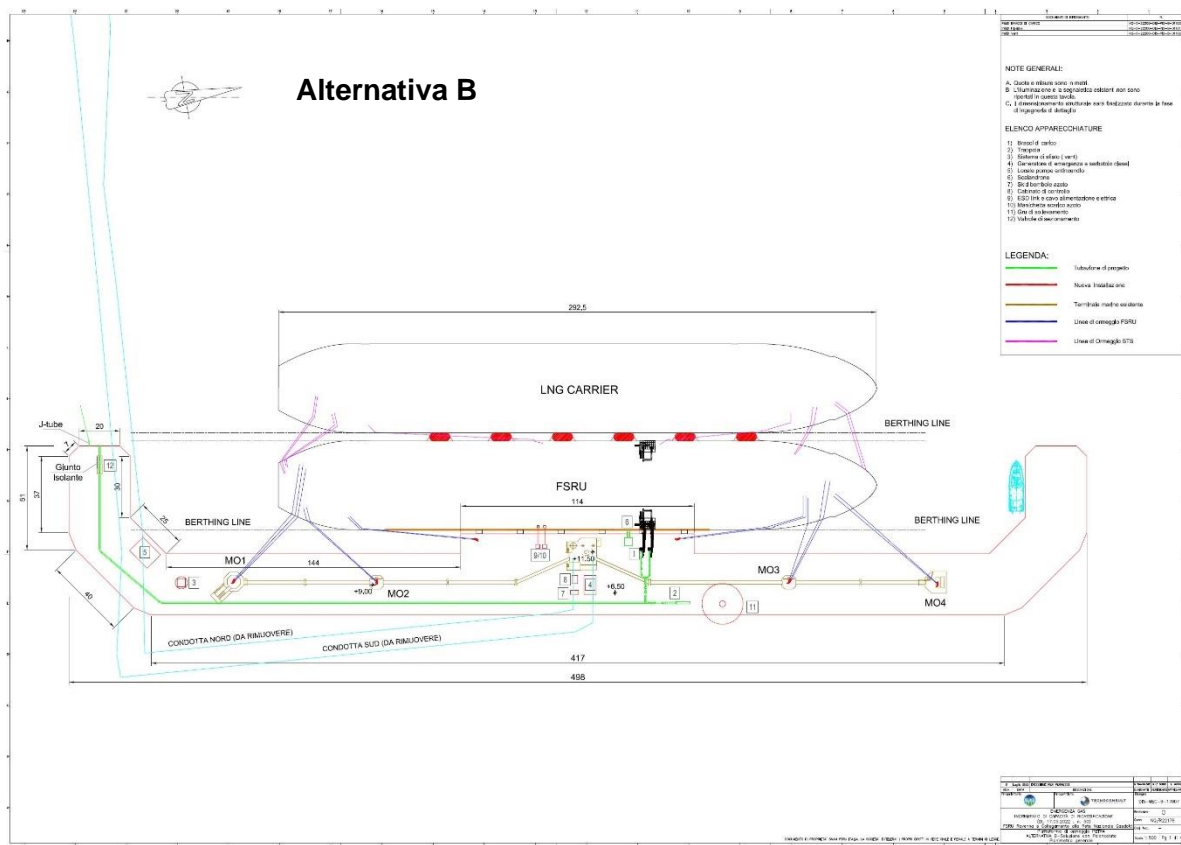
Layout di progetto Alternativa B [Rif. 2]
